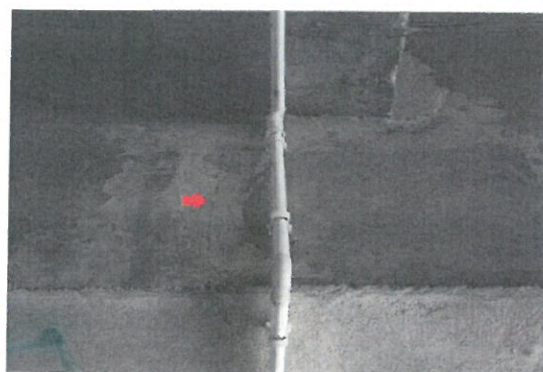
Zacieki i korozja betonu na murze oporowym przy połączeniu segmentu nr 1 z nasypem
